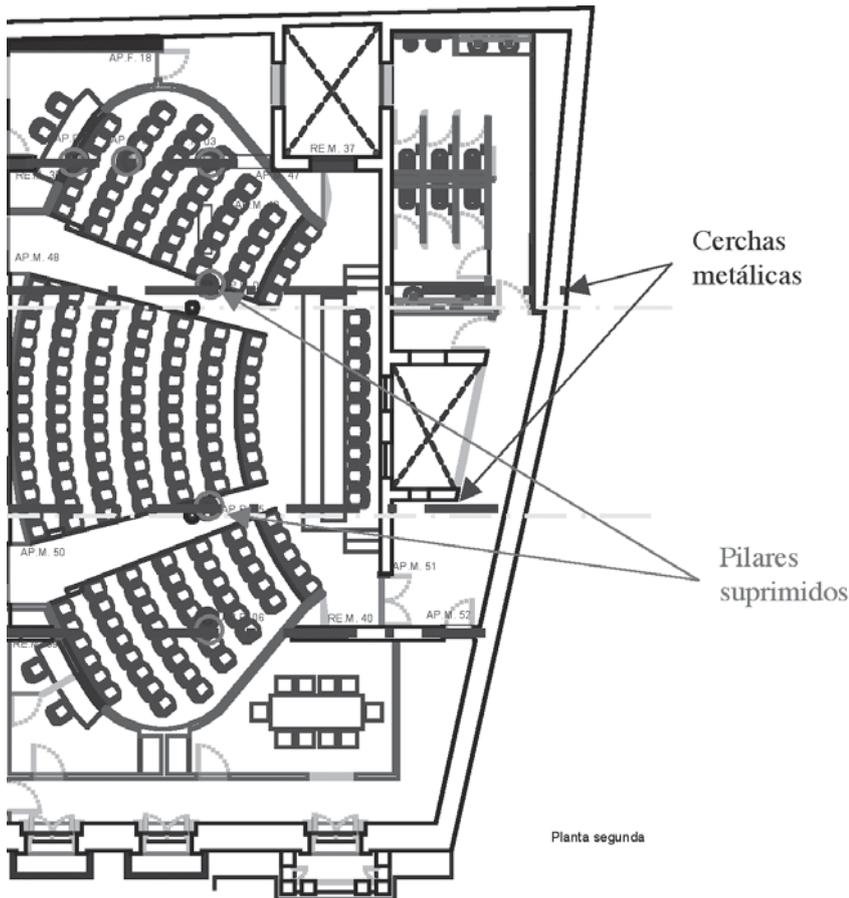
Croquis de planta de la localización de los pilares suprimidos en planta segunda.
